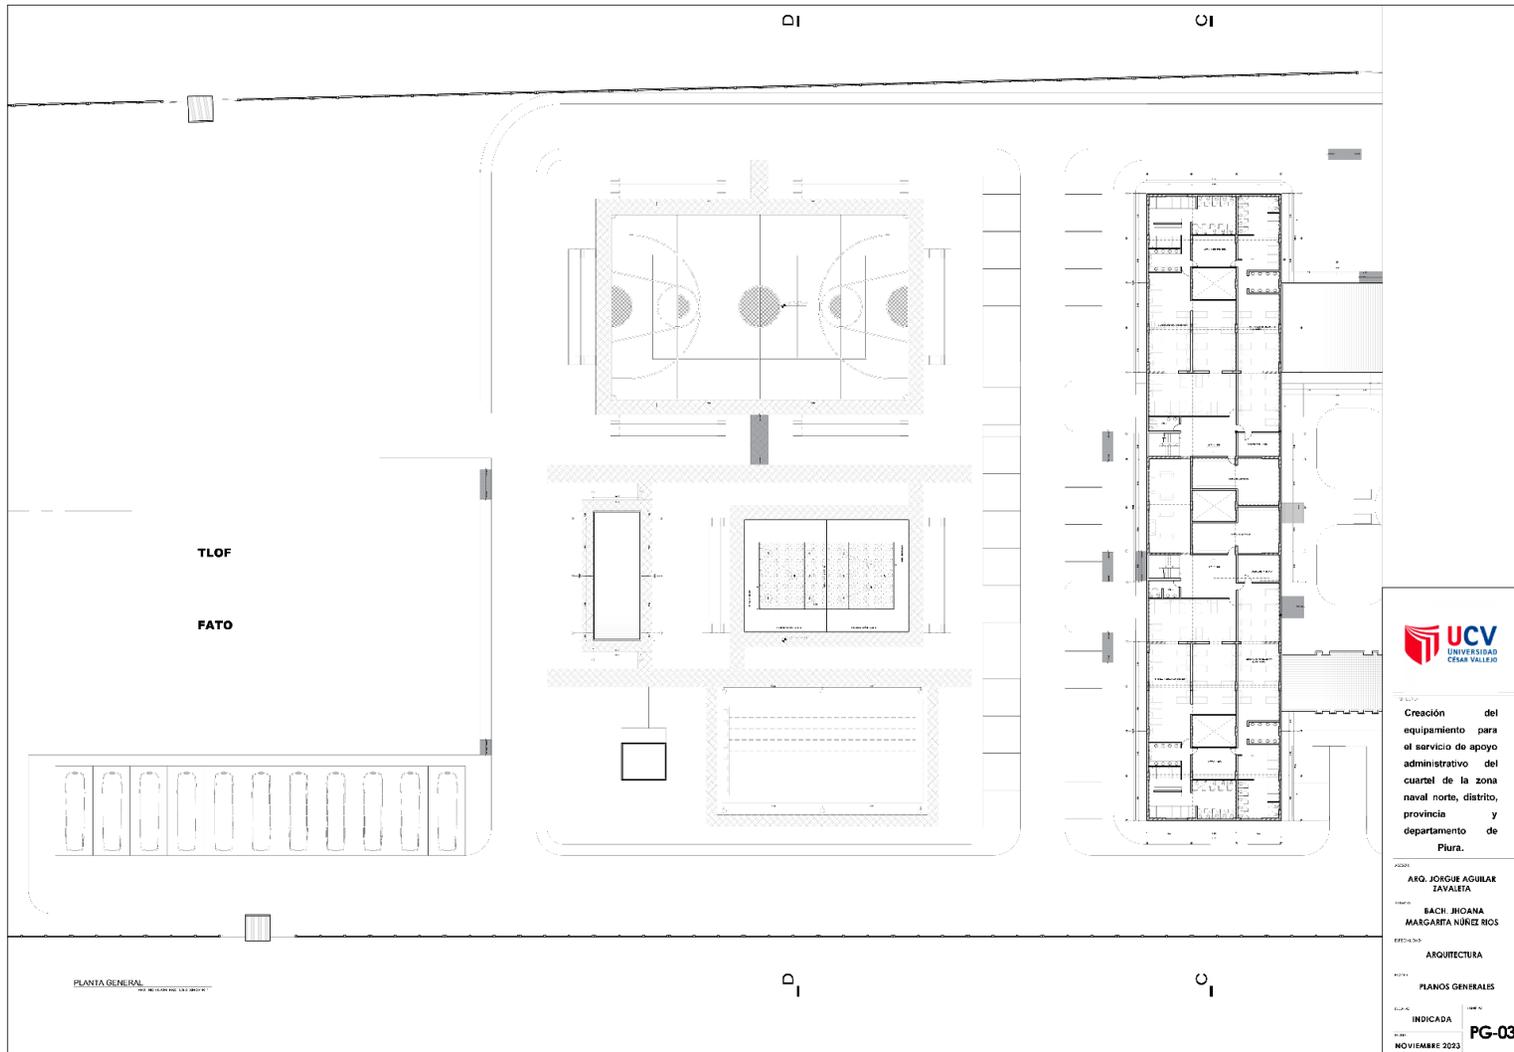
Planos Generales - Plano genera del segundo nivel – SECTOR 1
